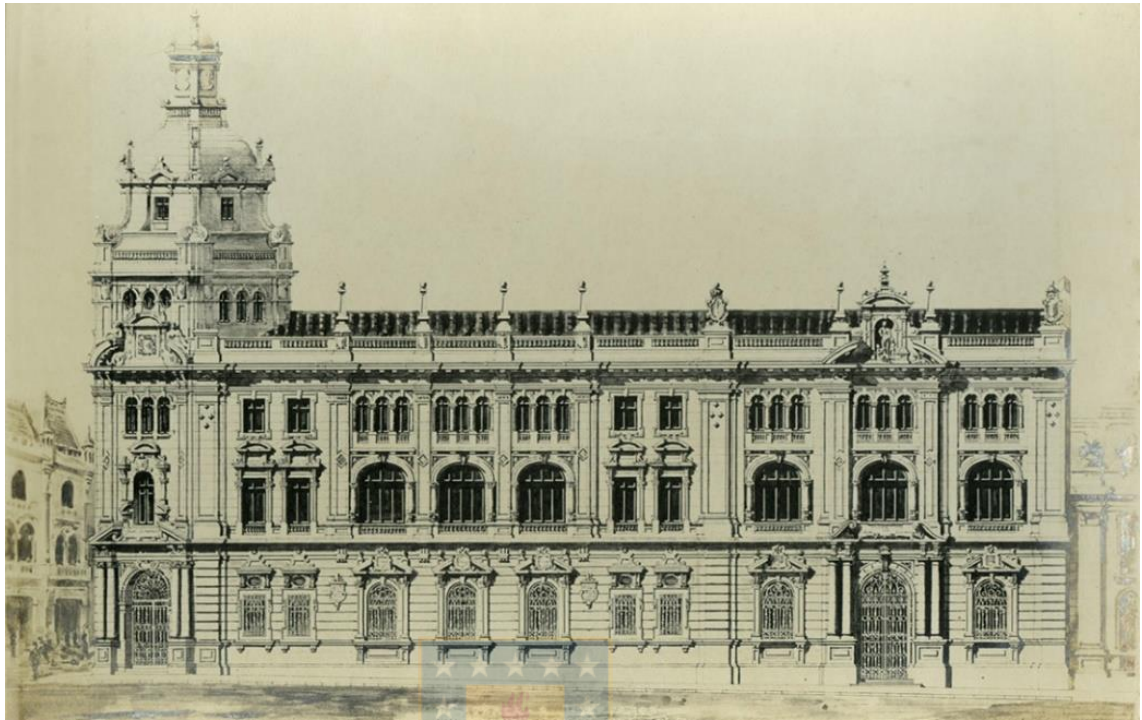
Elevación proyecto Caja de Crédito Hipotecario, Santiago.
